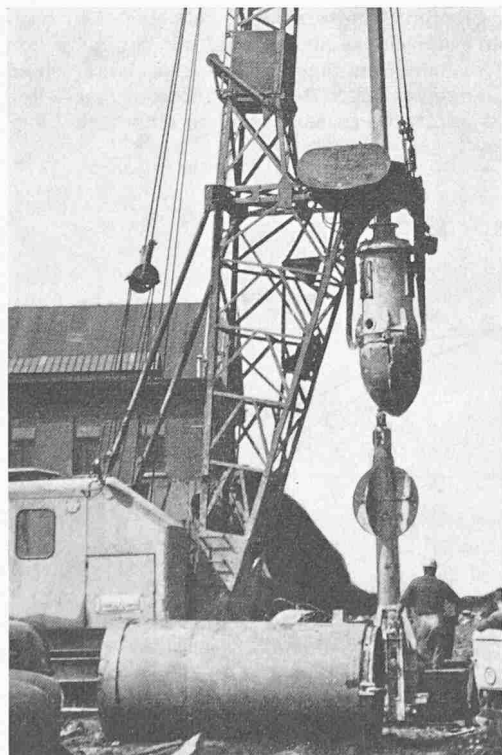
Bohrmaschine für Rohrdurchmesser 1,30 m
